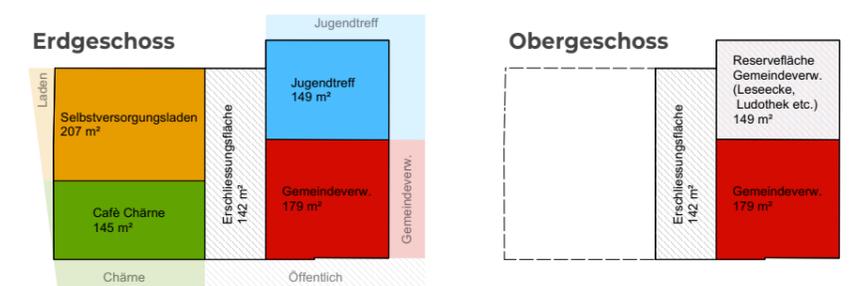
Eigene Darstellung schematischer Grundriss Winzenowa Scheune
